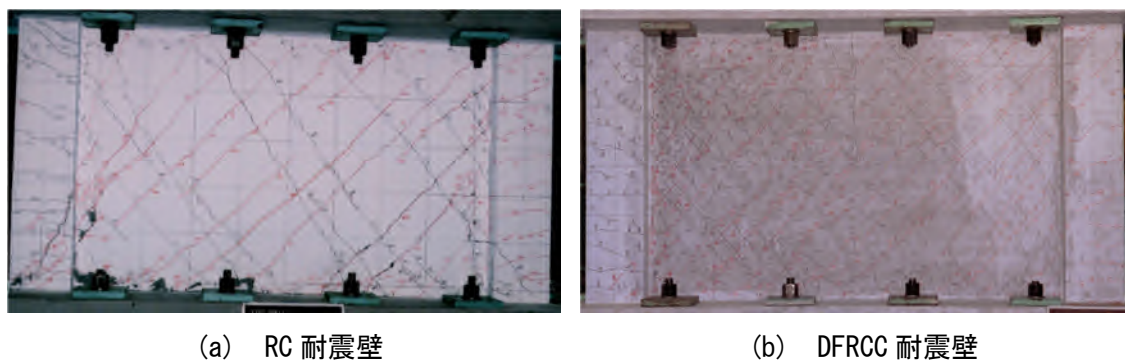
耐震壁試験体の破壊状況^{2.13)}
